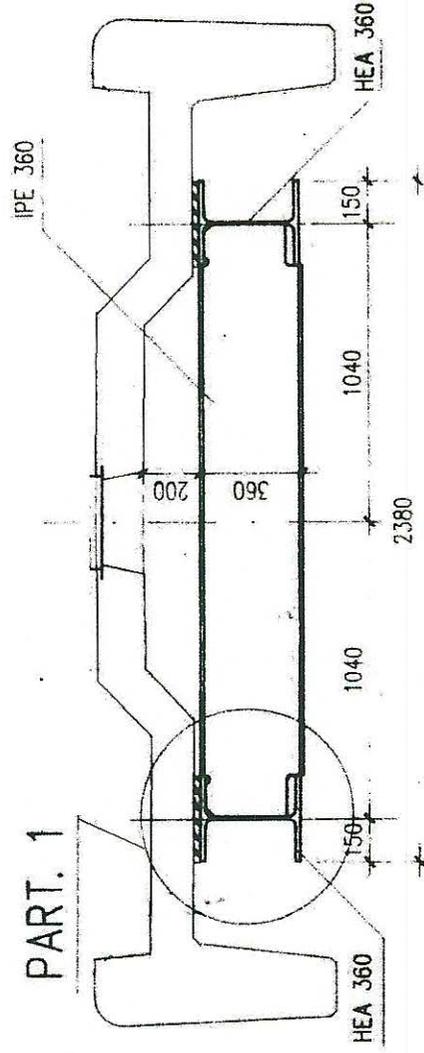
Sezione di pontile da 3.5 m rinforzato con telaio in acciaio.
